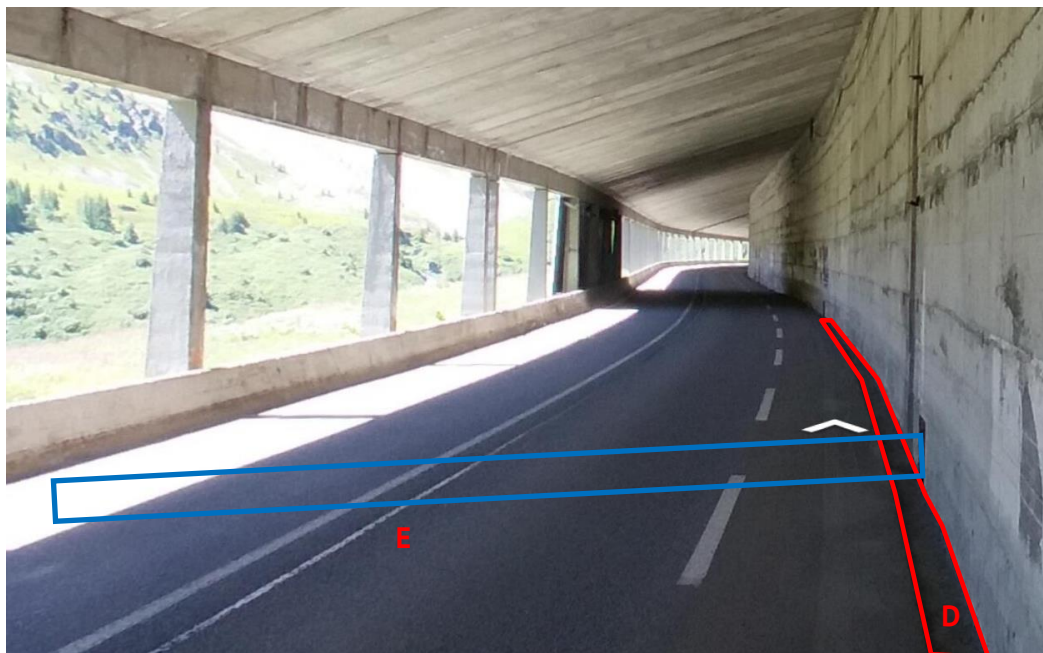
Utilisation des ouvrages hydrauliques sous chaussée
